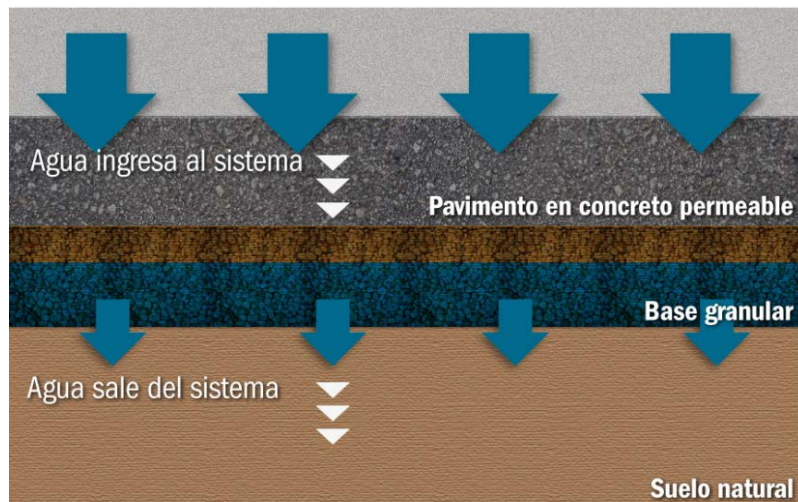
Funcionamiento pavimento permeable. (Fuente: Intromac)
